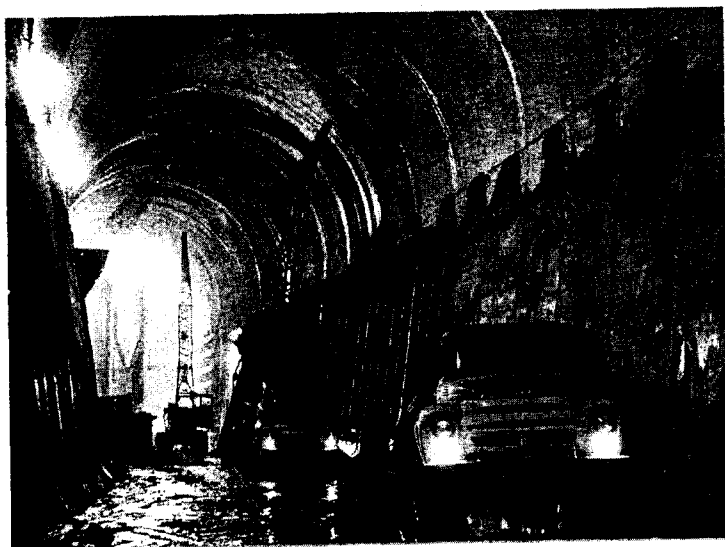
Монтаж опалубки стен и укладка бетона краном на нижнем уступе строительного тоннеля Чиркейской ГЭС
